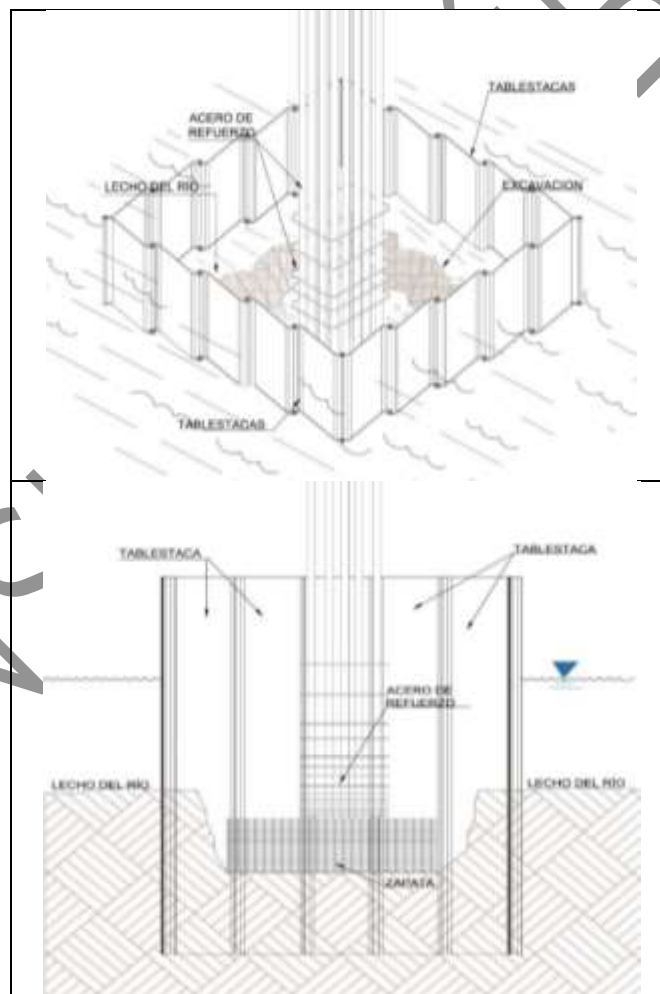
Ejemplo de colado de zapata de apoyo fuera del margen de un río.
